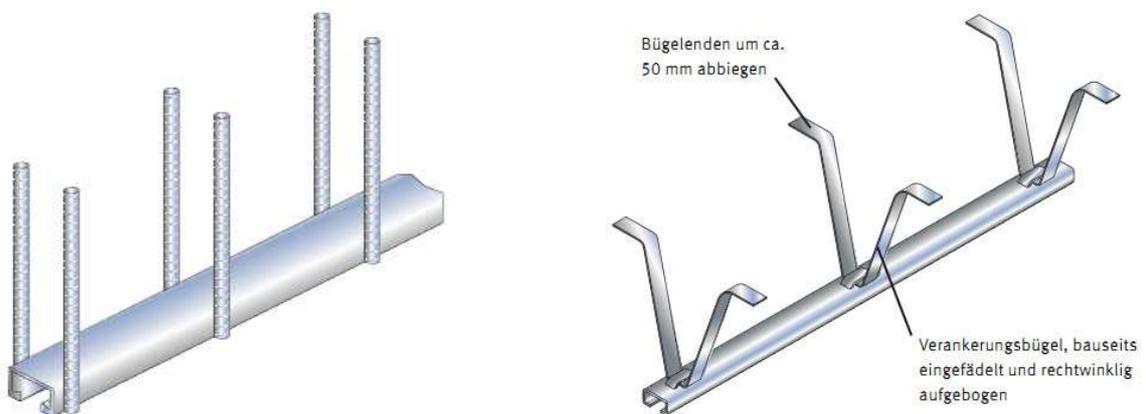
Ankerschiene mit beidseitig angeschweißten Betonstahlankern (li.) und Ankerschiene mit montierten Bügeln (re.) nach [25]
